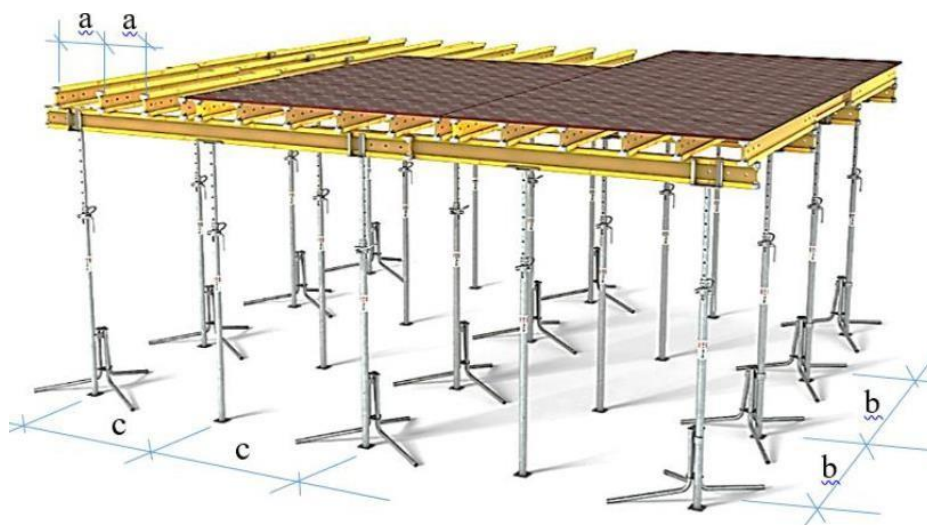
Схема складання опалубки плити перекриття PERI MULTIFLEX
